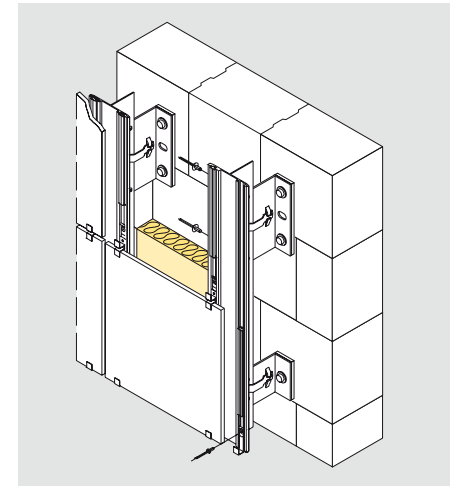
Aluminium-Unterkonstruktion mit Wandhaltern
